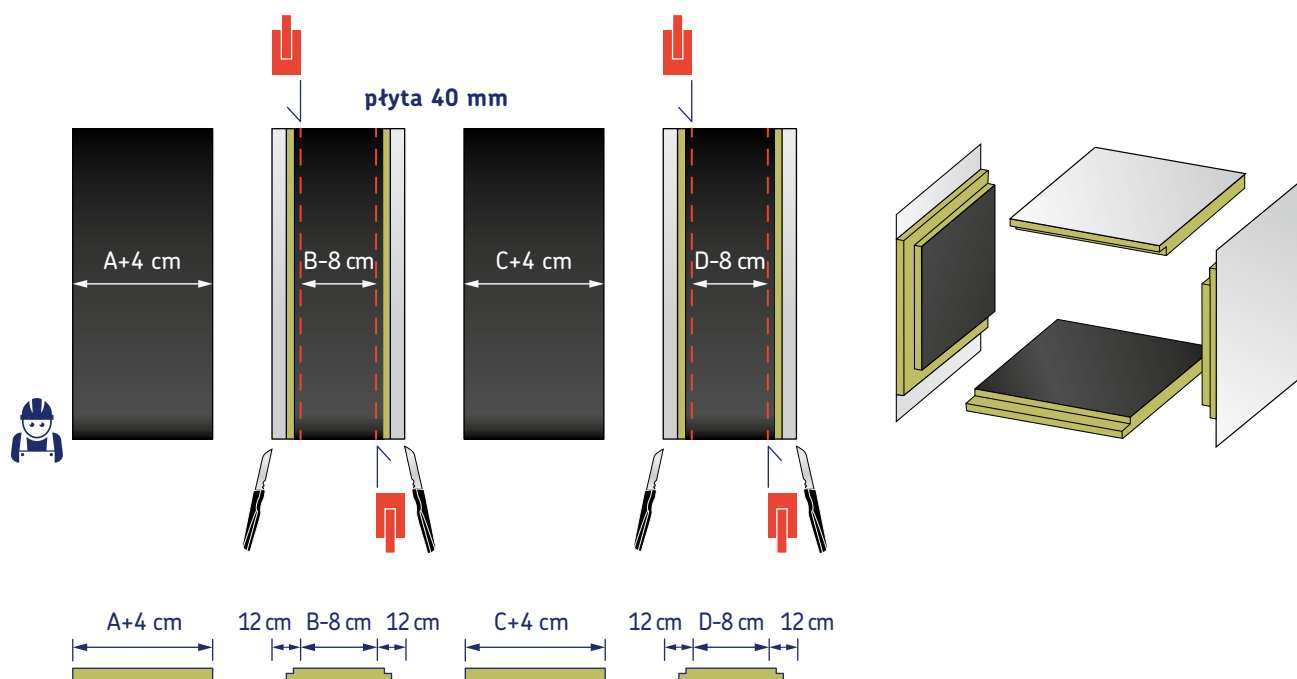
• Element odcinka prostego – ścianka z jedną zakładką (płyta 40 mm)
